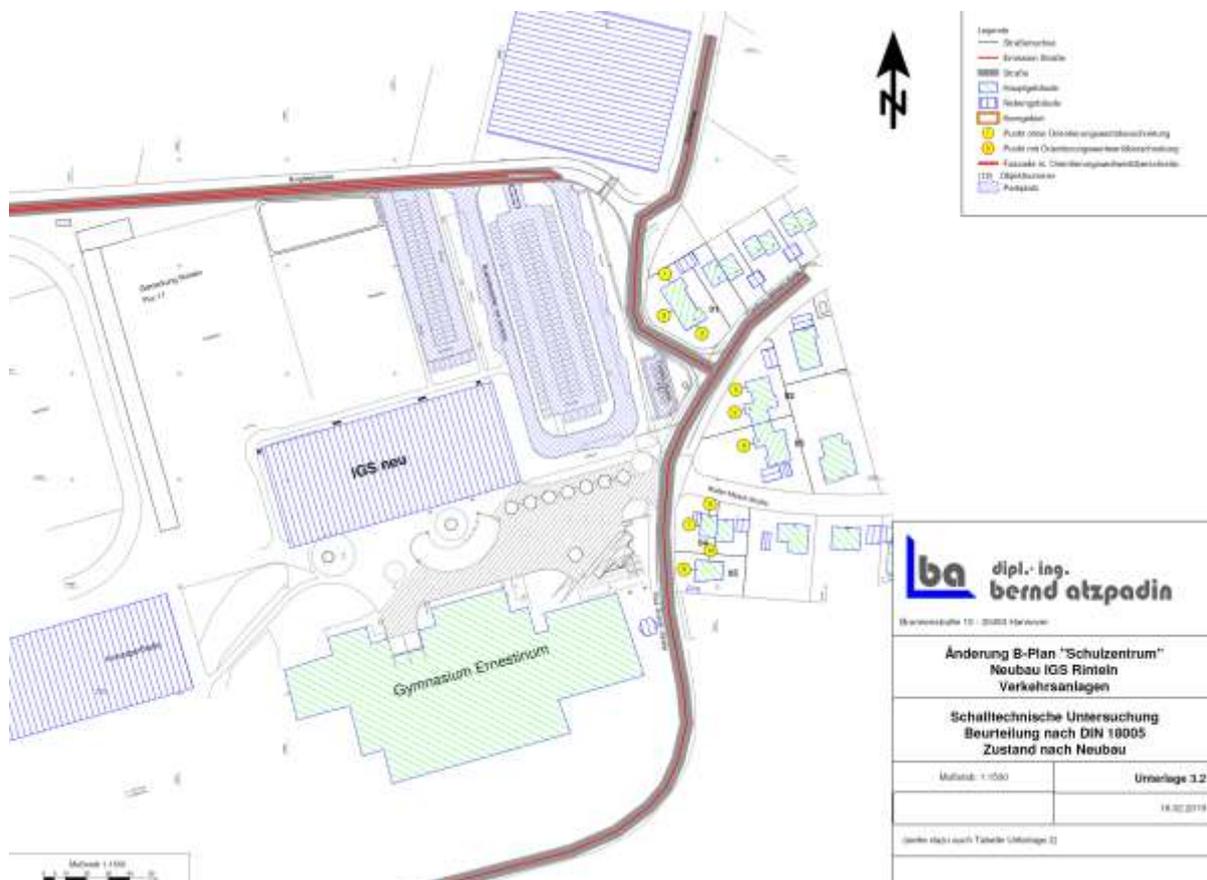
Lageplan zur schalltechnischen Untersuchung
